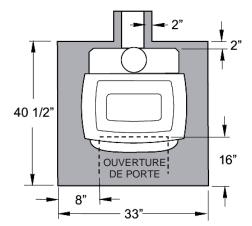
Dimensions minimales du protecteur de plancher, aux États-Unis.
